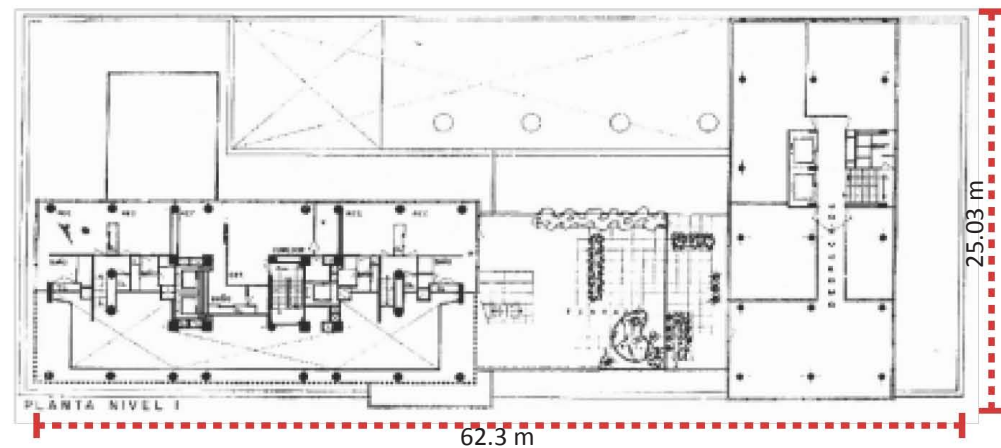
Planta tipo del Caso Estudio. Fuente: Creación propia.
